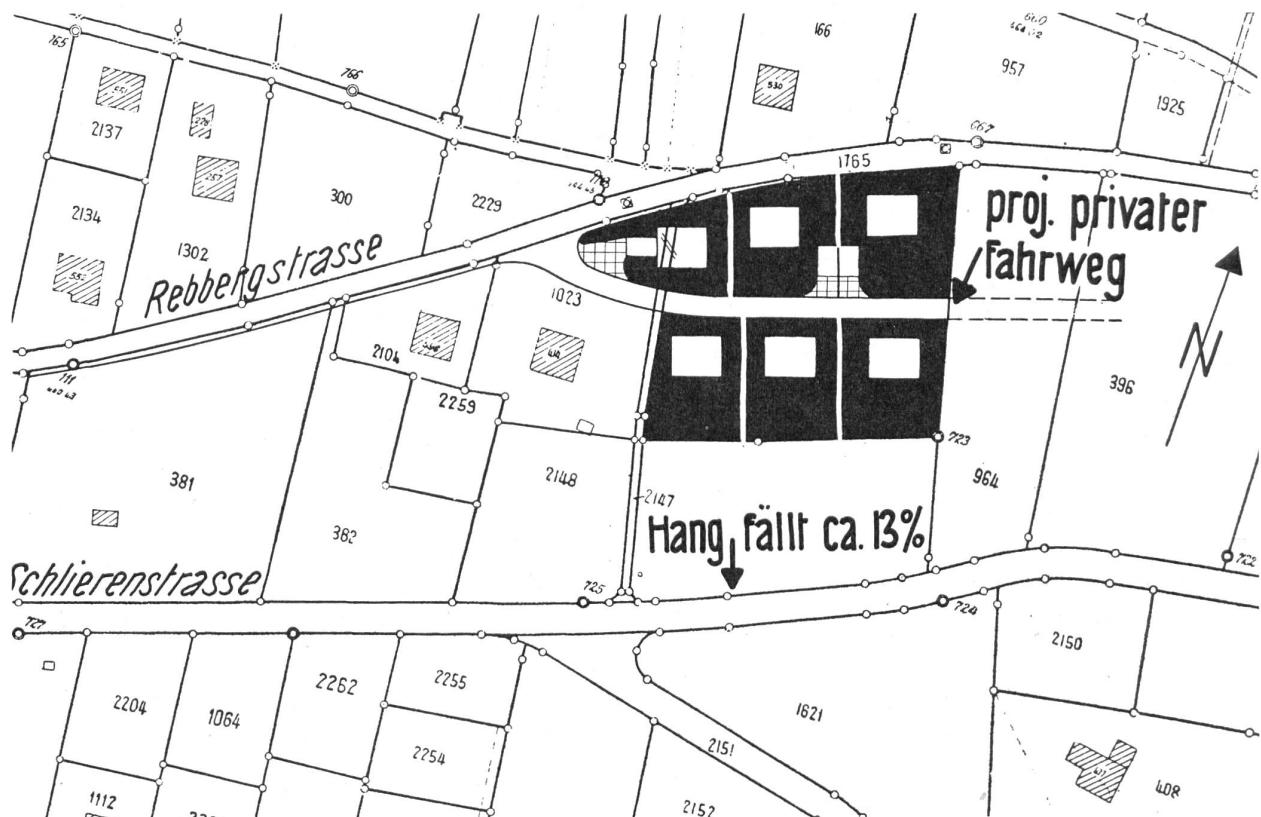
Situationsplan zu der von den privaten Bauinteressenten vorgenommenen Erschliessung. Dem fahrbaren Privatweg gebührt der Vorzug vor den bisher üblichen Zugangstreppen. Im Hanggebiet stellt die zweckmässige Erschliessung besonders hohe Anforderungen.
